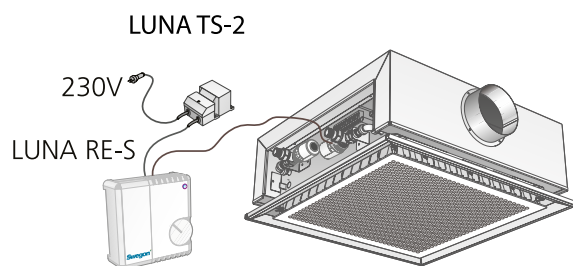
Installazione, raffreddamento ad acqua e riscaldamento elettrico
